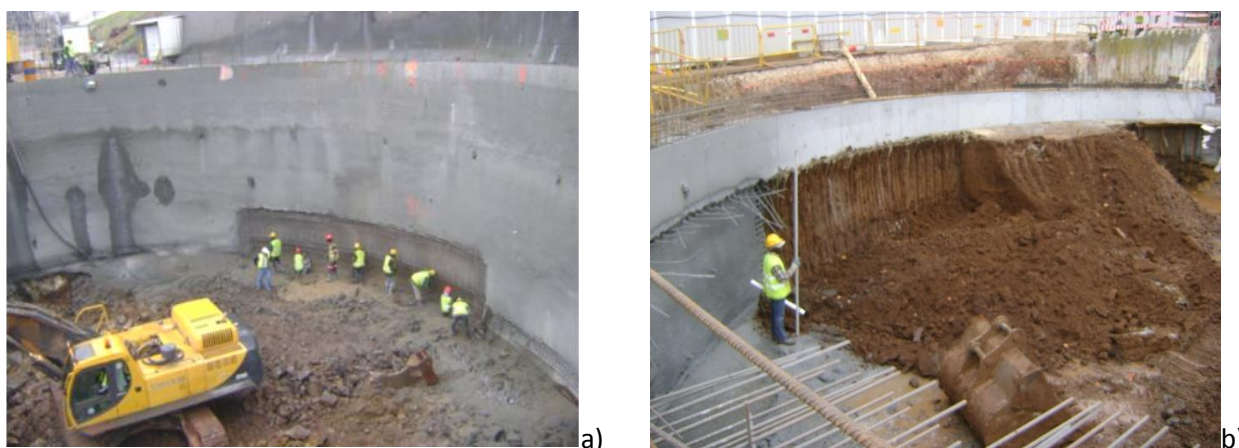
a) Aplicação da malha sol após 1ª camada de 4 cm de betão projetado. b) Abertura de painéis intercalados para execução de revestimento primário.
